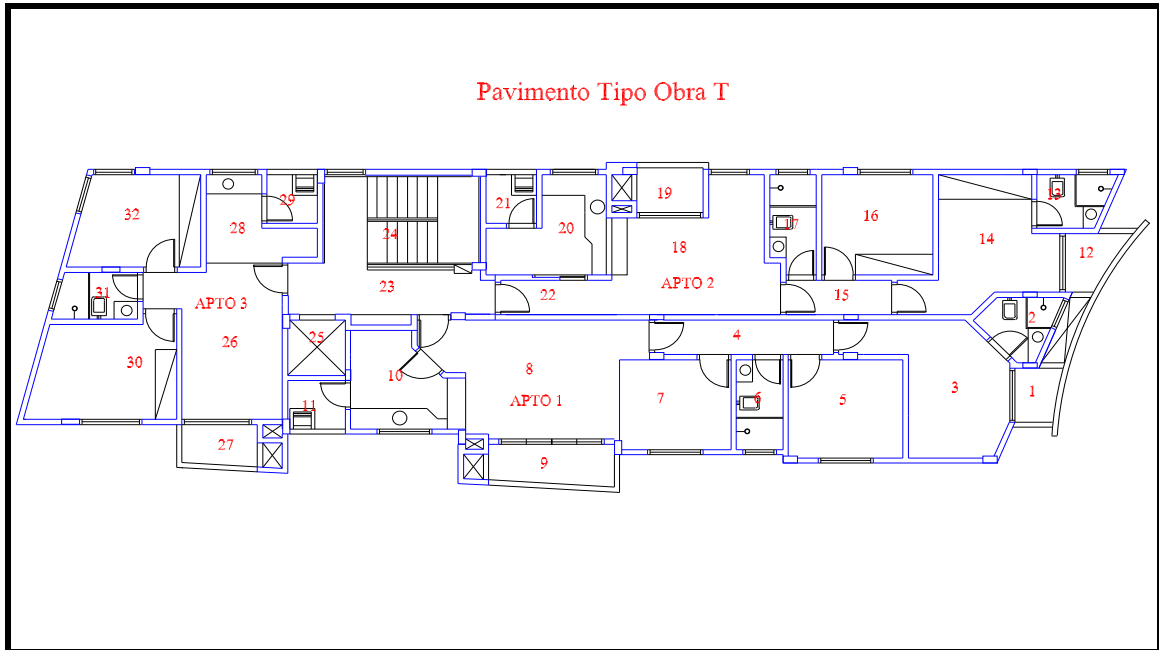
Zoneamento do pavimento tipo obra T (dados da pesquisa).
